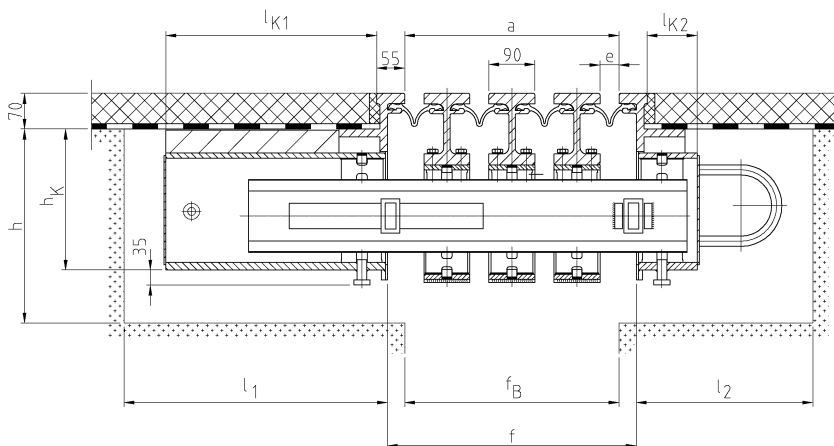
Situation und Bezeichnungen zu den Aussparungsabmessungen
